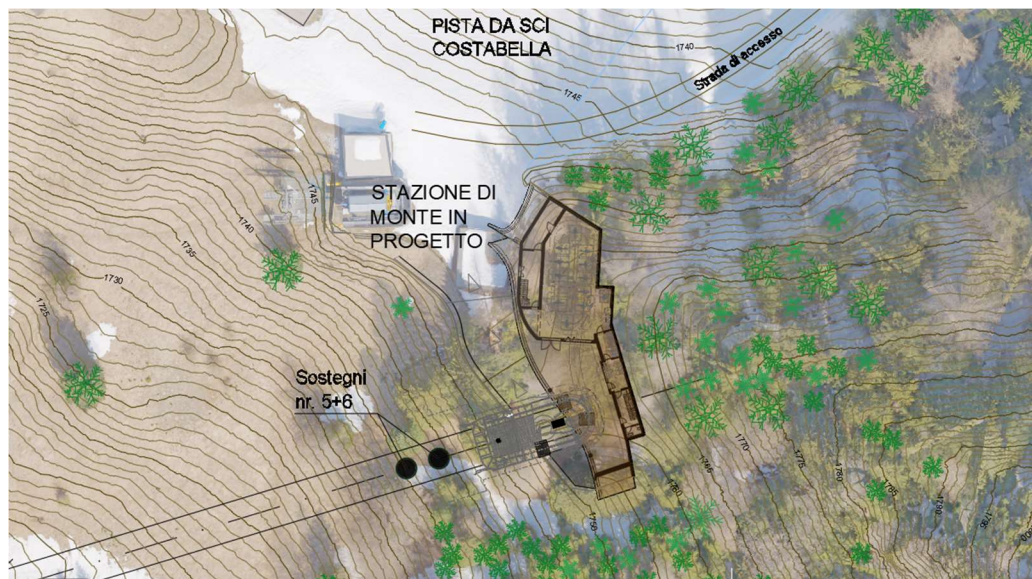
estratto dalla planimetria - stazione di monte in progetto
